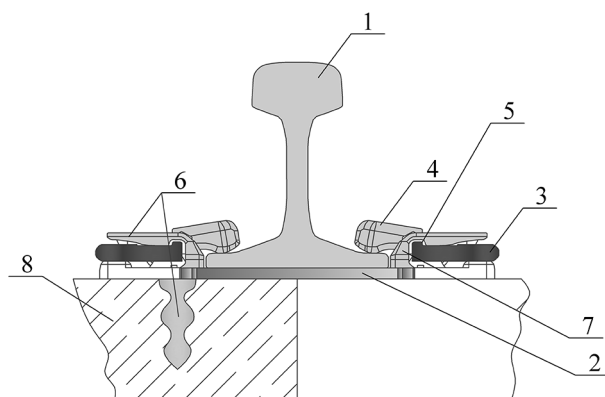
Рельсовое промежуточное скрепление системы Pandrol 350: 1 — рельс; 2 — подрельсовая прокладка; 3 — упругая клемма; 4 — прижимной изолятор; 5 — фиксатор рабочего положения; 6 — анкер; 7 — боковой опорный изолятор; 8 — шпала
